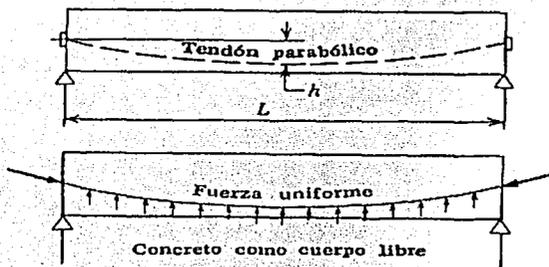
Viga de concreto presfuerzo como cuerpo libre.
